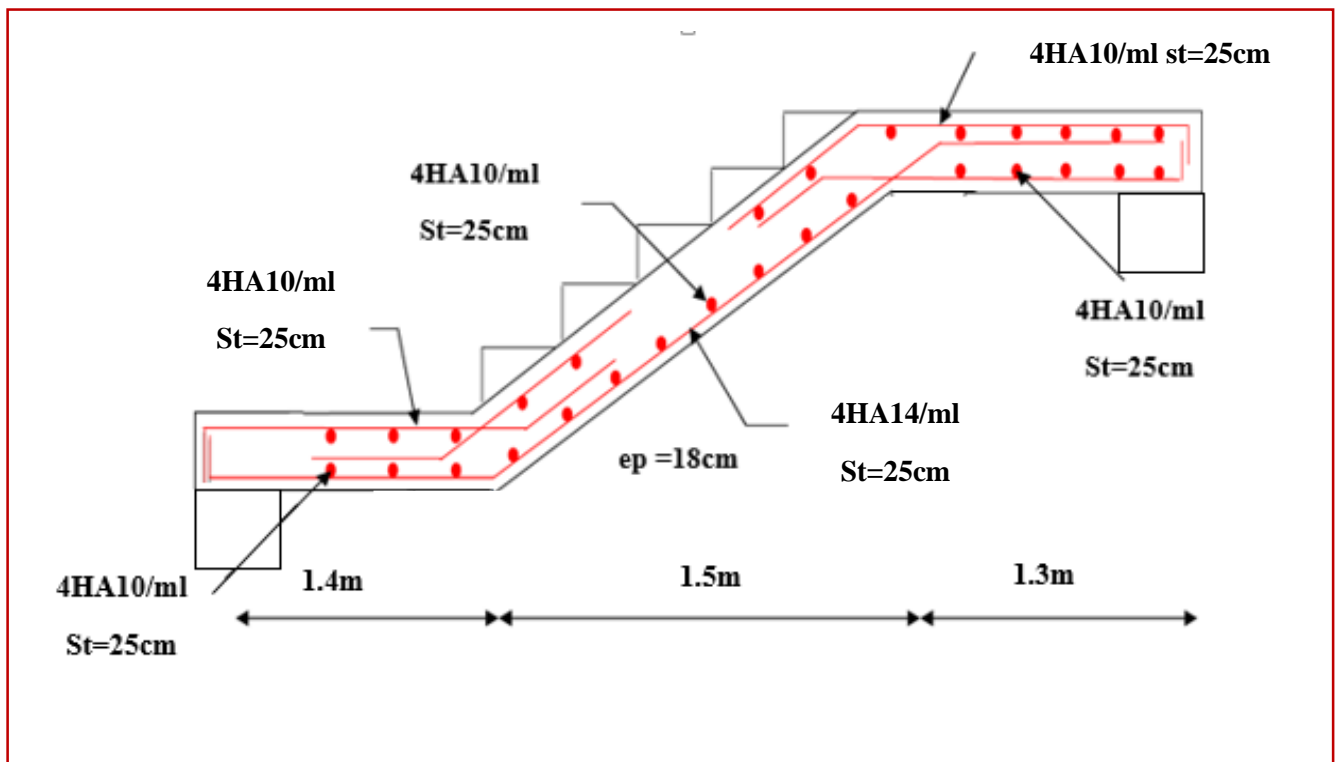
schéma de ferrailage de l'escalier d'entre sol.
